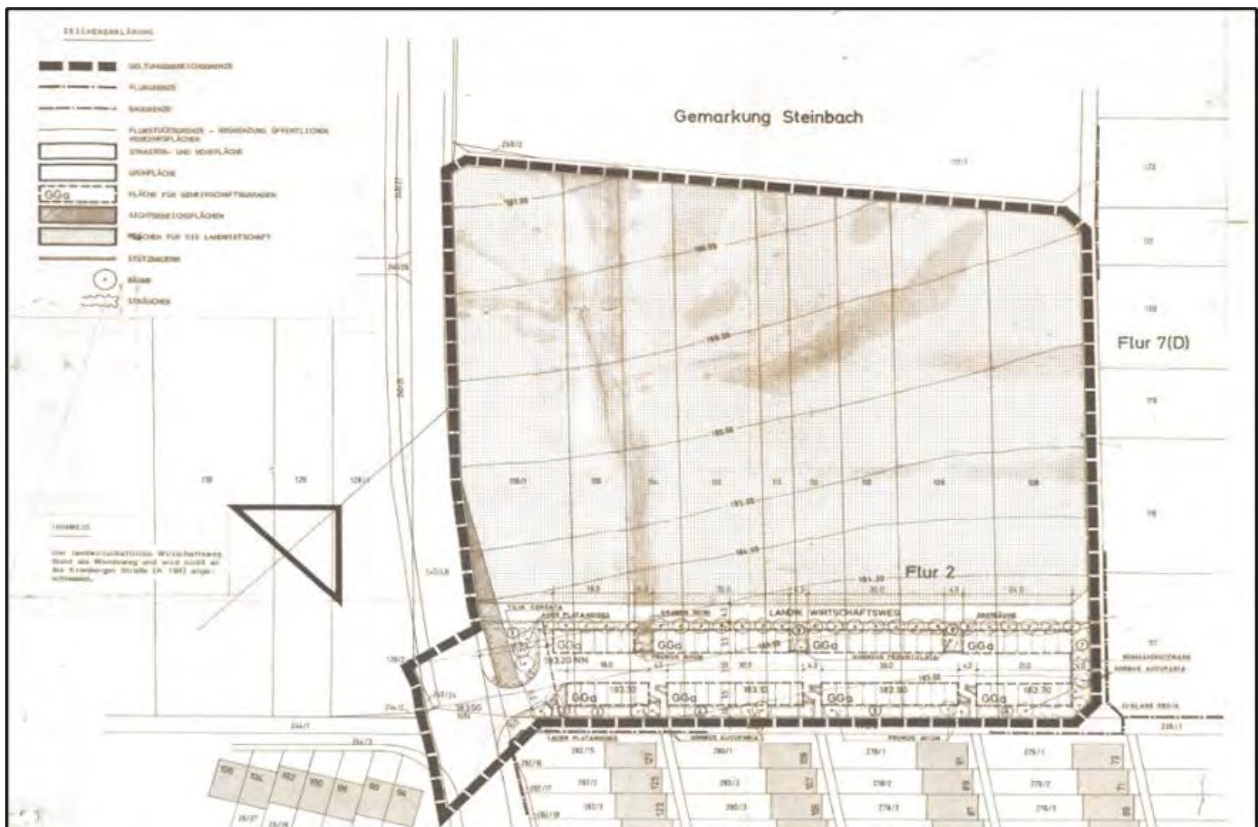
Bebauungsplan „Garagenhof Baugebiet hinter der Obergasse“ von 1987. (Quelle: Stadt Steinbach)
